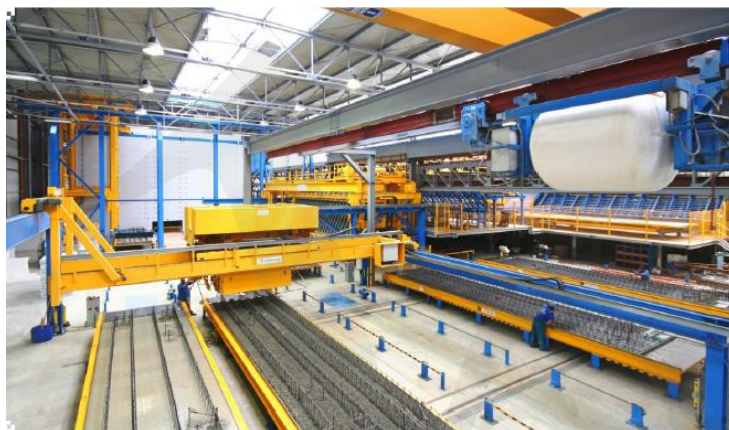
Produção de paredes duplas e pré-lajes [17]
